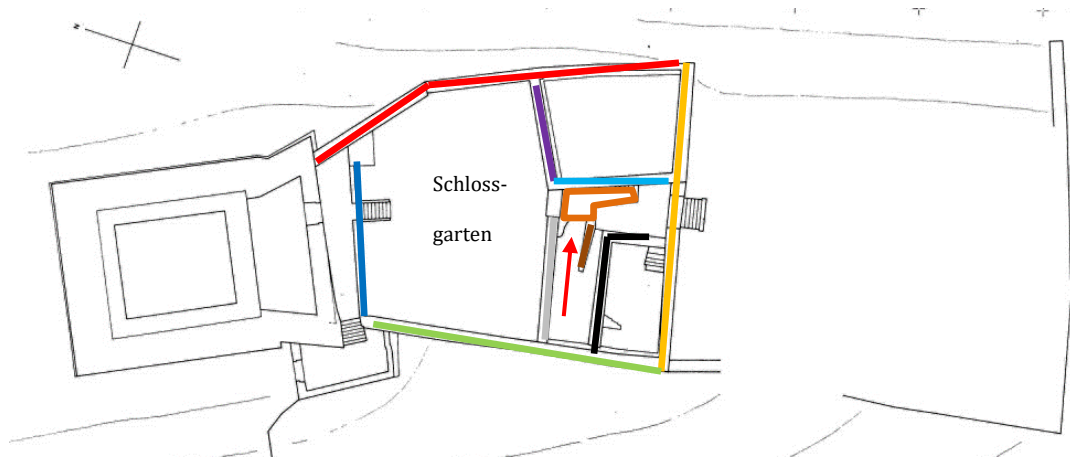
Grundriss, Ausschnitt überarbeitet
